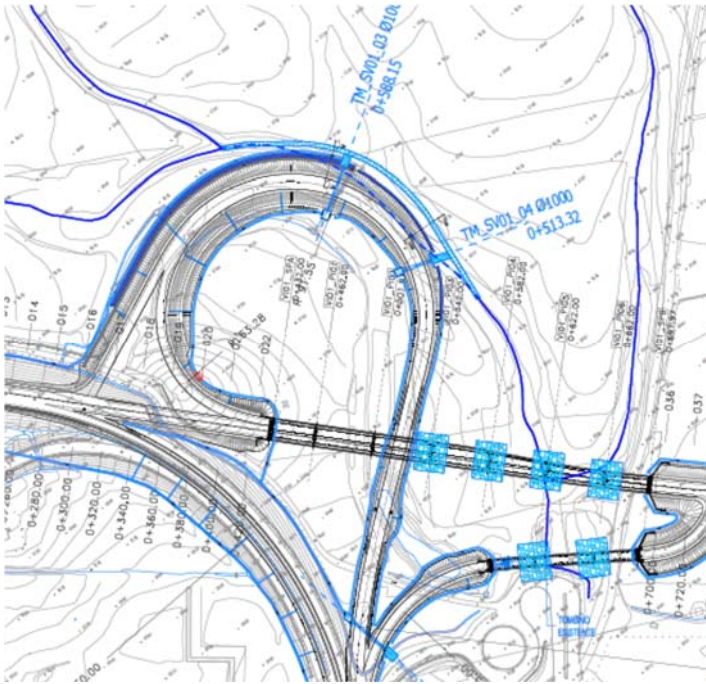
Torrente Burgio – planimetria con indicazione delle protezioni svincolo SV 01
